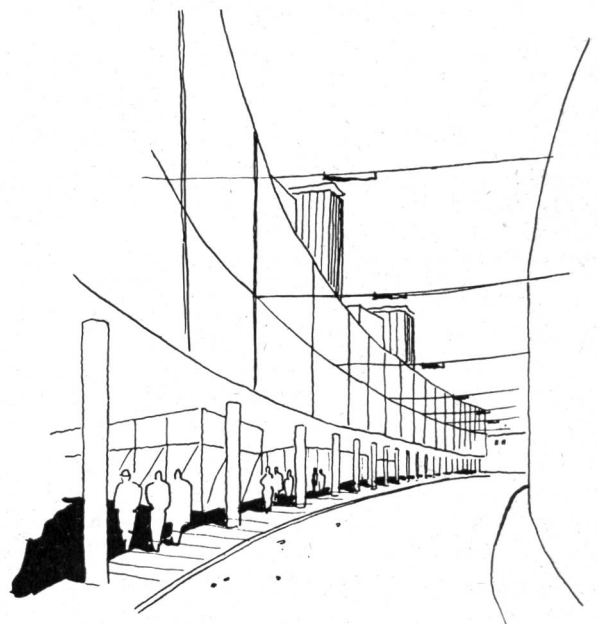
Perspektivische Skizze einer neuen Citystrasse mit niederer Längsbebauung, hohem Querblock und offenem Erdgeschoss mit Fussgängerpassagen.
